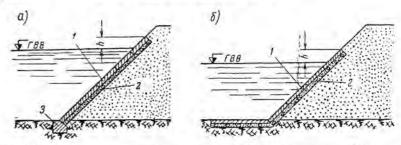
Конструкция укрепления откосов насылей бетонными плитами (h зависит от высоты волн):
